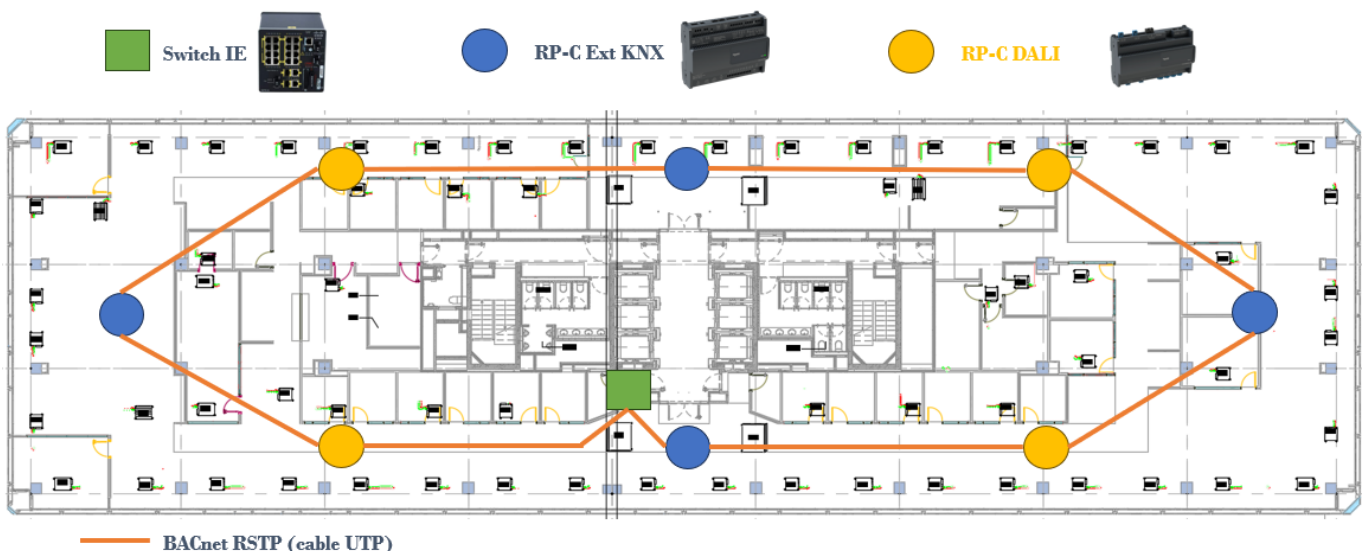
Distribución y cableado controladoras RP-C por planta
